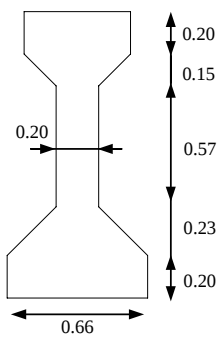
Sección de viga de concreto presforzado del puente Pinzandarán
